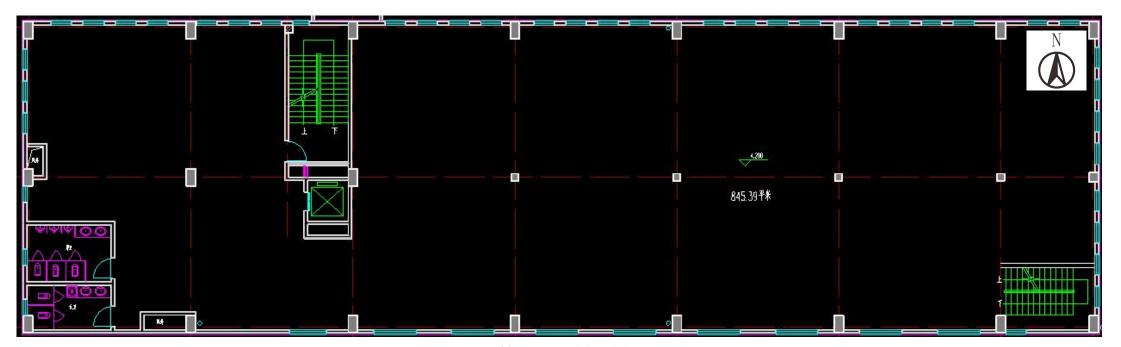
1#楼 2 层平面布置图(1: 100)
